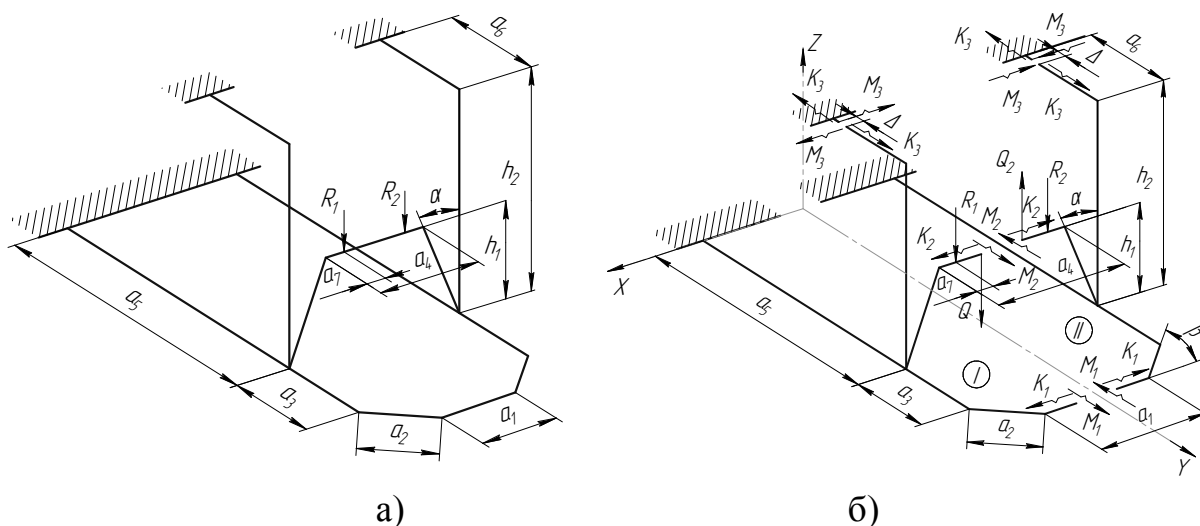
Задана (а) та розрахункова (б) схема кріплення вентиляторної установки
